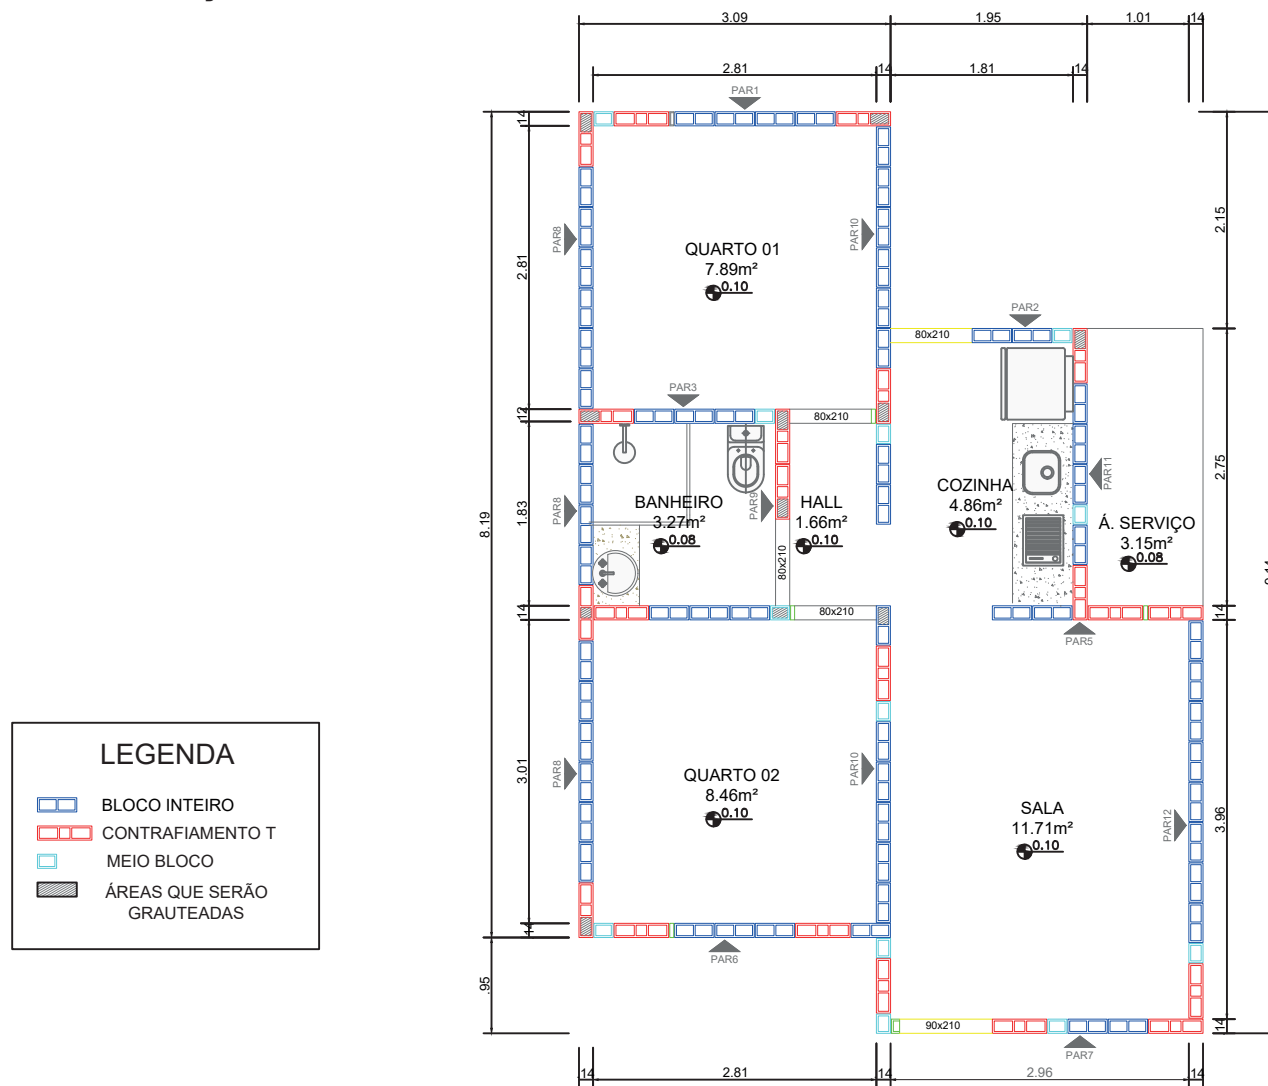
FiguraXI: Planta de Modulação - Alvenaria Estrutural Fiada 01
